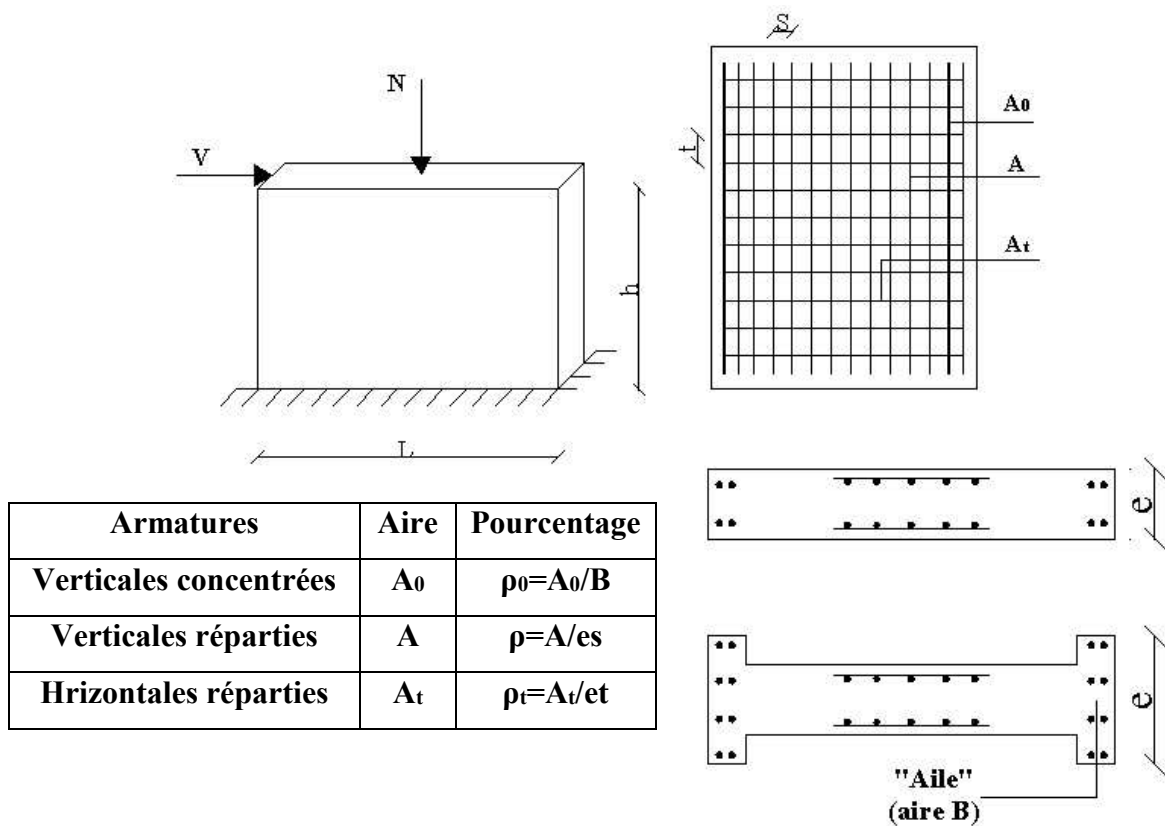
Schéma d'un voile plein et disposition du ferrailage
